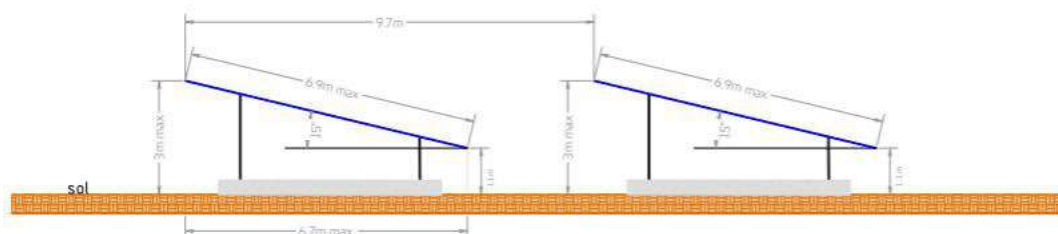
IMAGE D'UN EXEMPLE DE PLAN DE COUPE D'UNE CENTRALE SOLAIRE SUR GABION –
